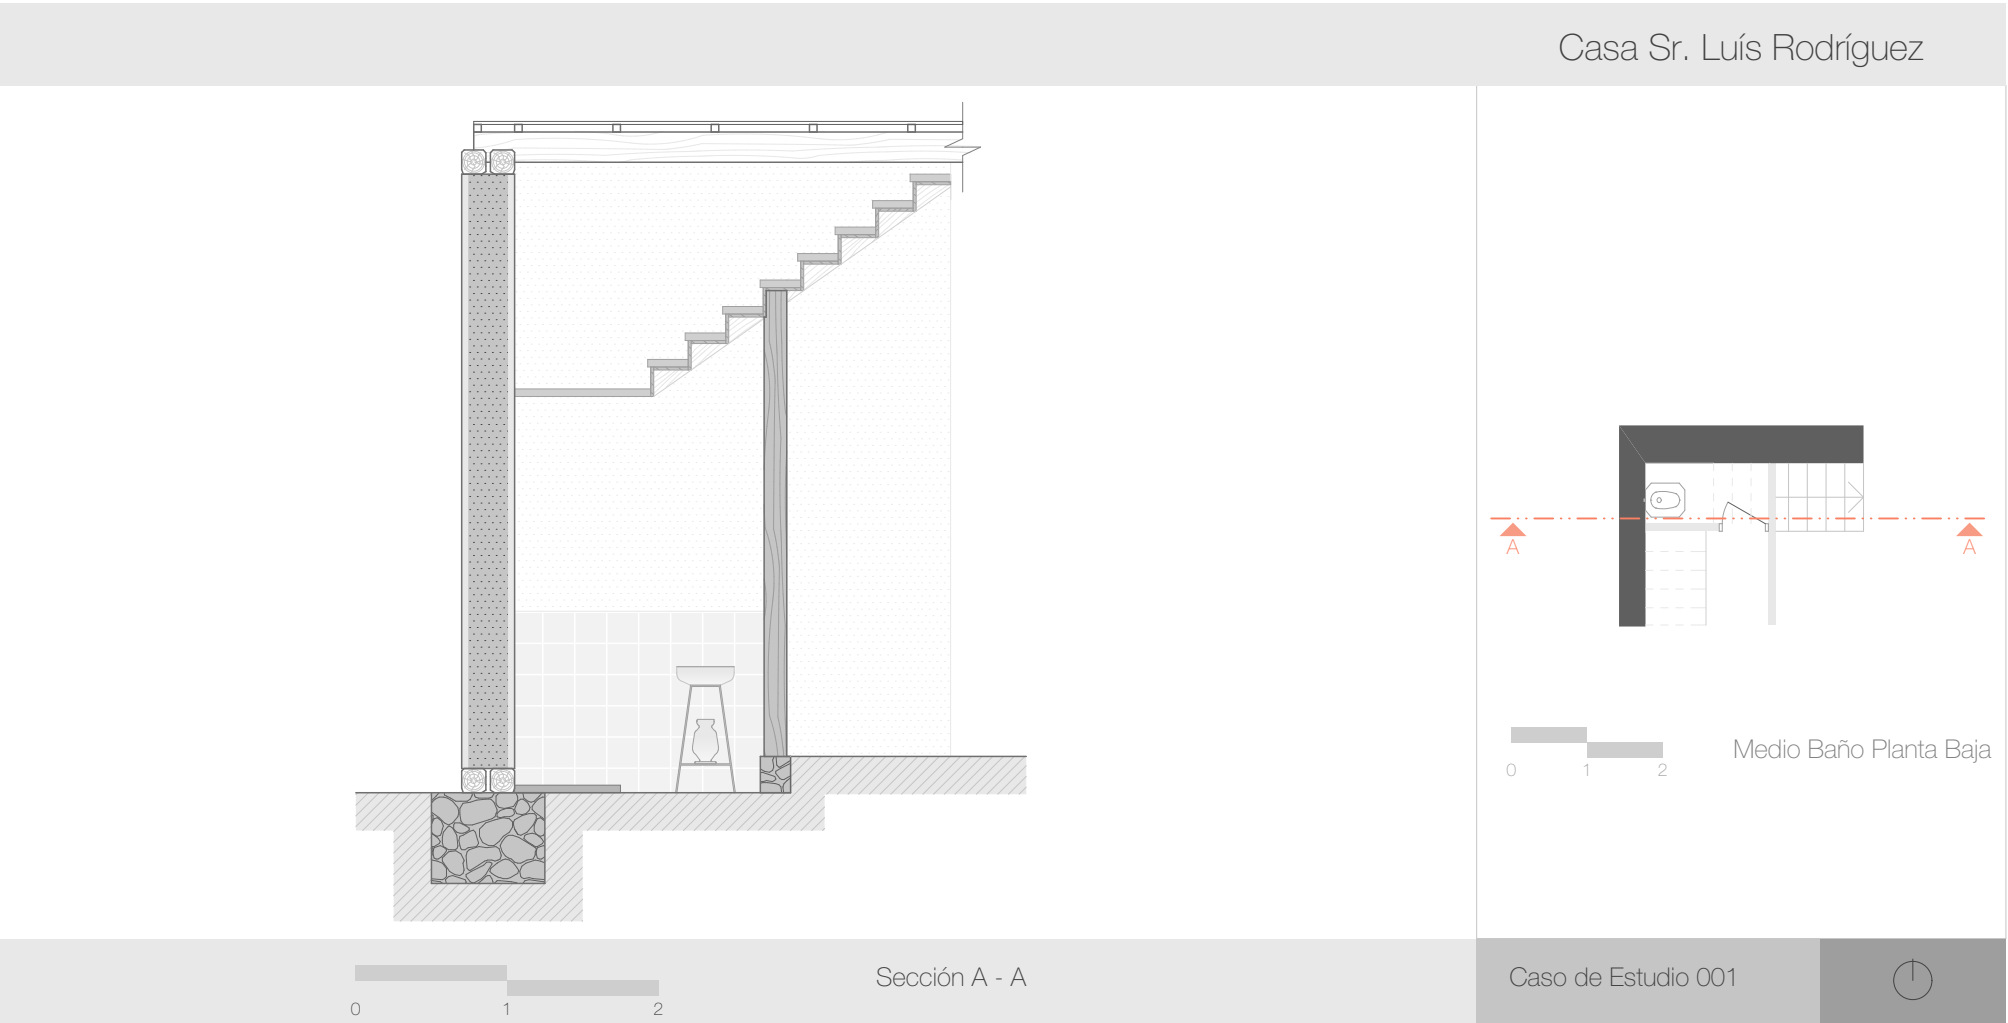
Mobiliario sanitario empleado en la Vivienda Rodríguez Planta Baja
